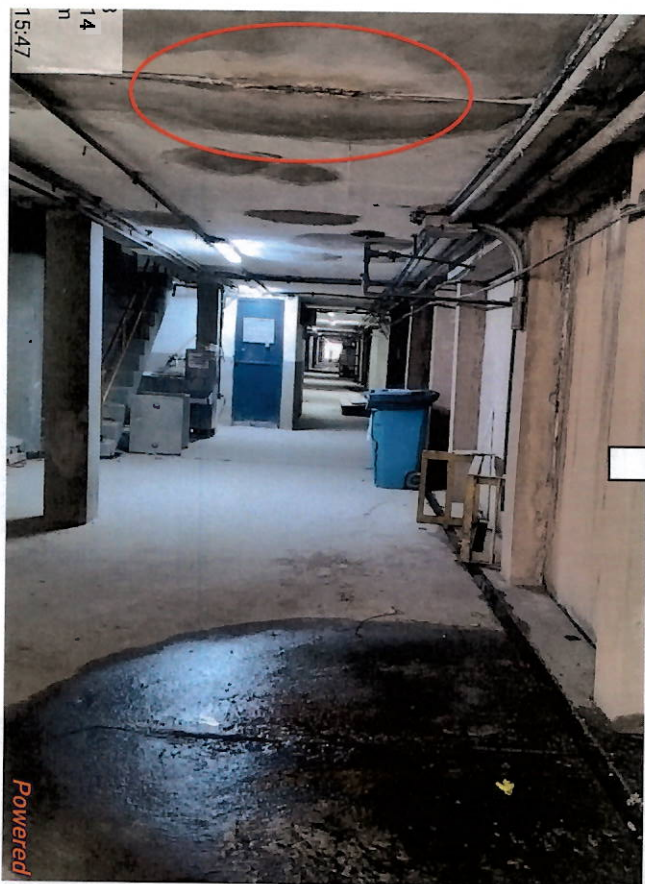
vazamento de água no teto, proveniente da calha do decantador (piso molhado indicando vazamento).
